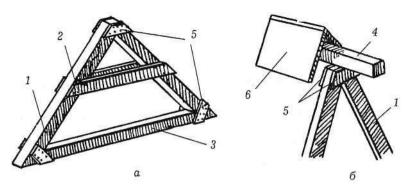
Стропильная рама, укрепленная ригелем: a — стропильная рама; δ — коньковый узел: 1 — стропила; 2 — стропильный ригель жесткости; 3 — перекрывающая балка; 4 — конек; 5 — деревянные накладки; δ — кровельное покрытие
